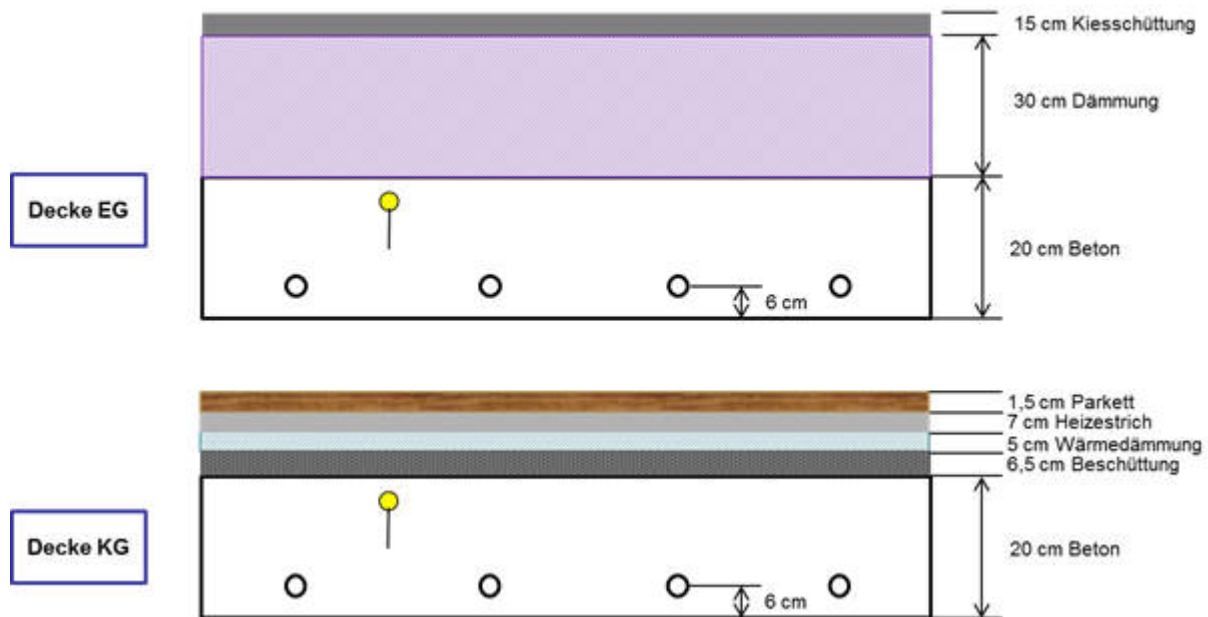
Aufbau der bauteilaktivierten Decke Kellergeschoss (KG) bzw. der obersten Geschossdecke (Decke EG) inkl. Fußbodenaufbau (Quelle: Planer, eigene Darstellung)
